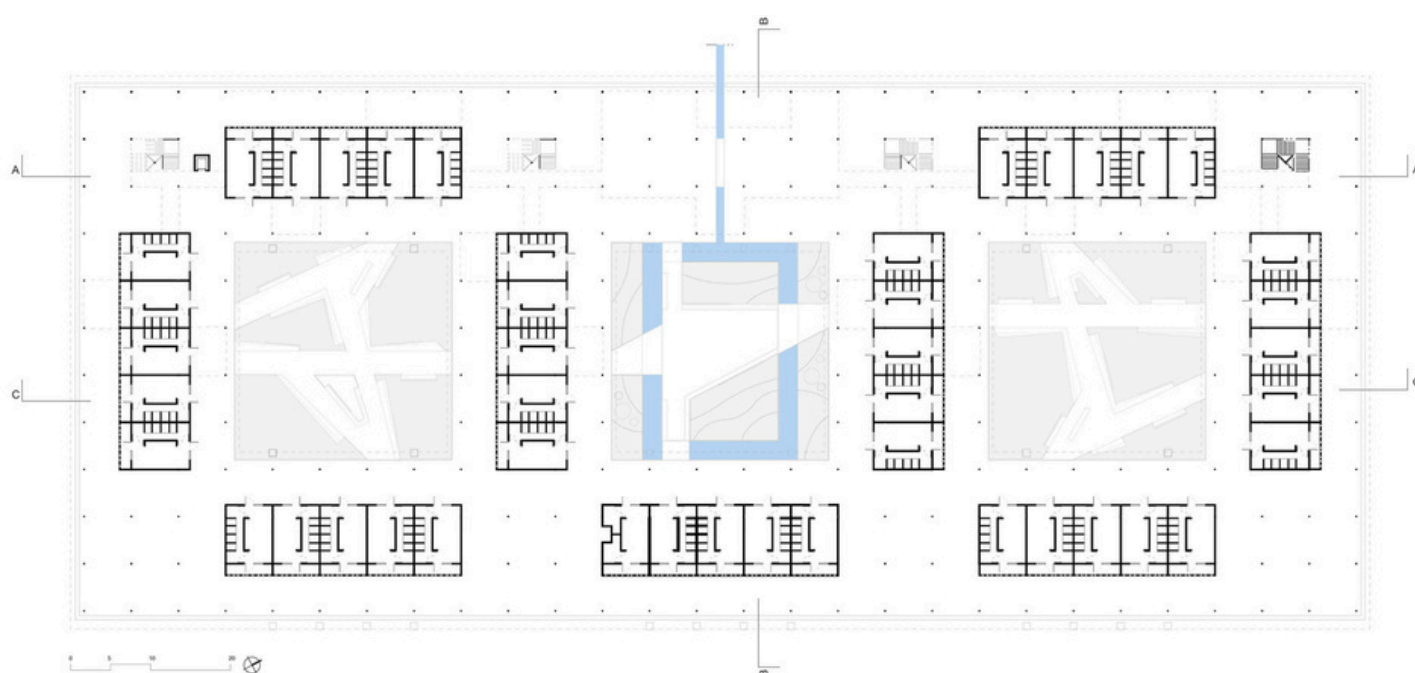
Planta Baixa do Pavimento Térreo das Moradias.
